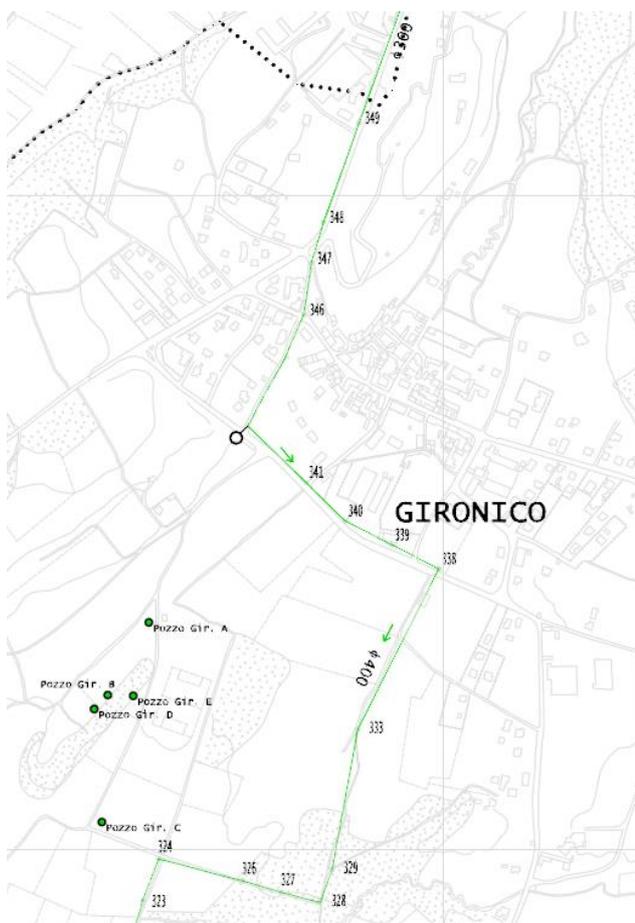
Rifacimento collettore consortile previsto nello studio della rete, zona Gironico - da cameretta 349 a 329
